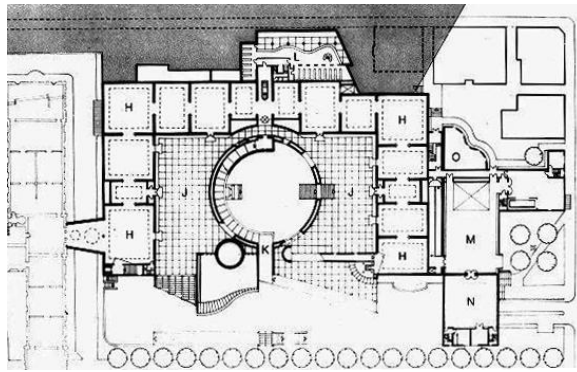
| Planta Alte Staatsgalerie | Great Buildings
